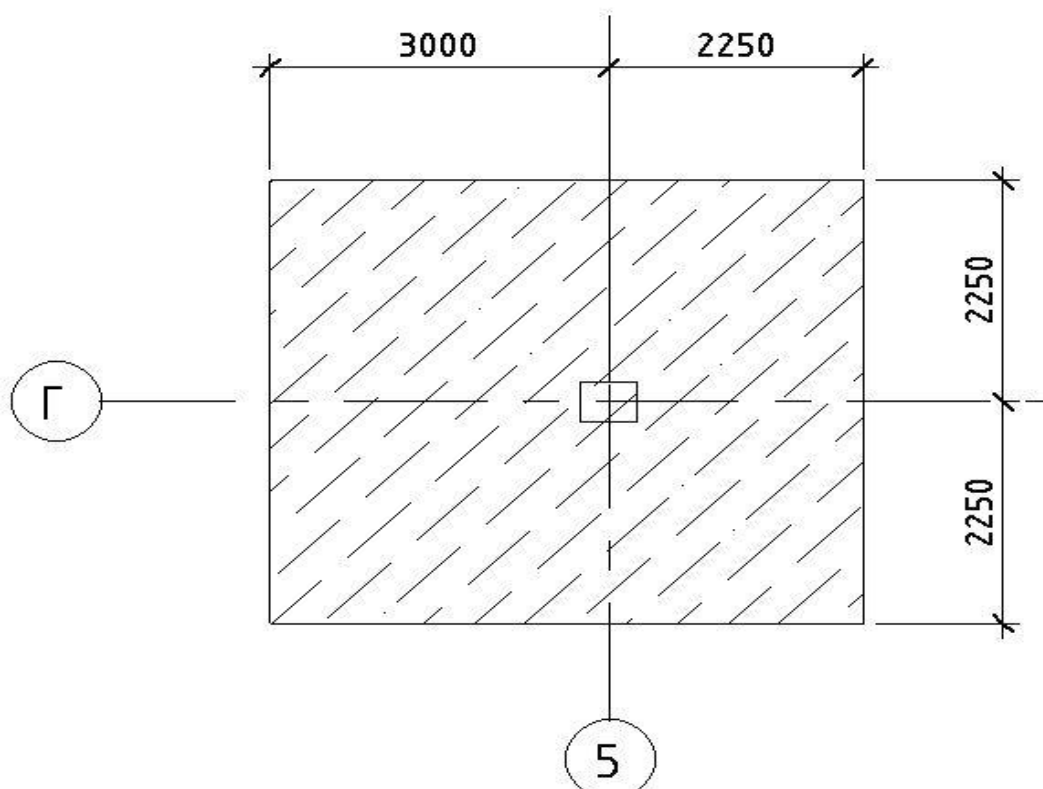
Грузовая площадь колонны среднего ряда.
